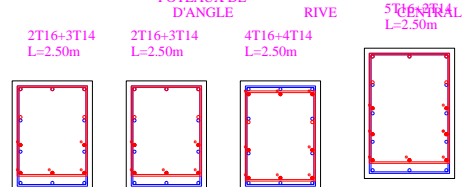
DETAIL DE CHANGEMENT A-A DU SECTION : 45X60 à 40x55 POTEAUX DE D'ANGLE
